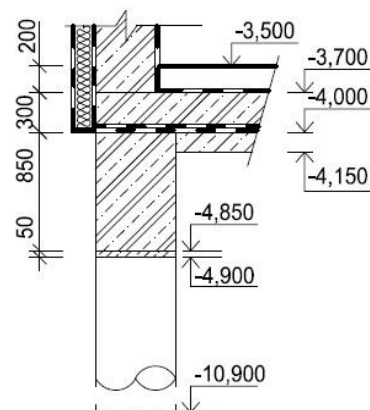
Řez základovým pasem pod obvodovou stěnou [V]
